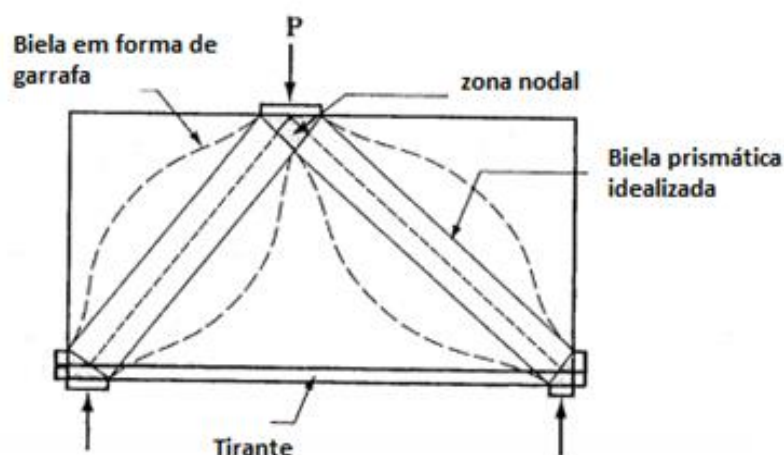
Modelo biela-tirante para uma viga parede de concreto, Silva (2017)
